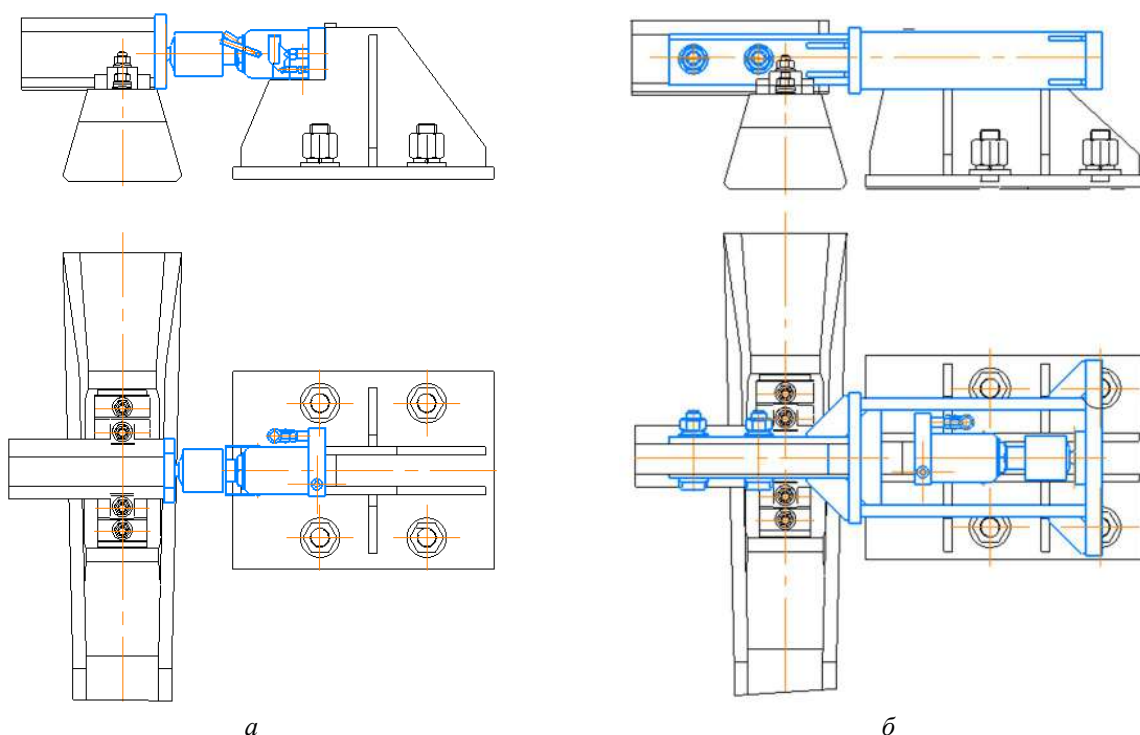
Исполнение конструкции стенда для испытаний рельсошпальных решеток на сжатие (а) и растяжение (б)
